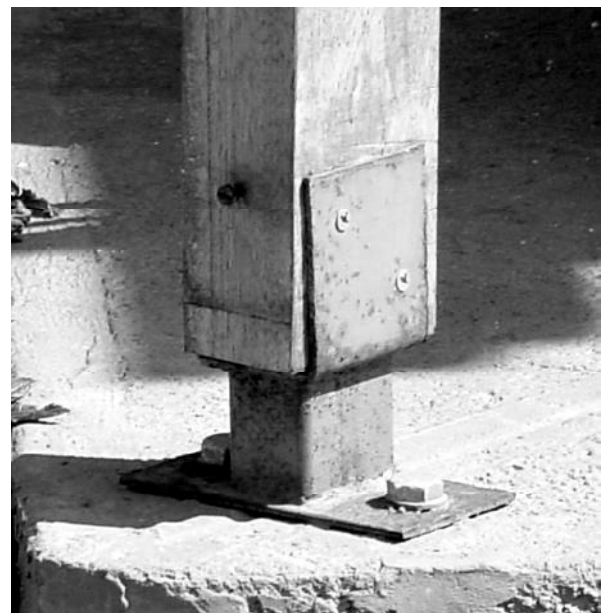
Aislamiento de columnas de madera por medio de conectores metálicos.
